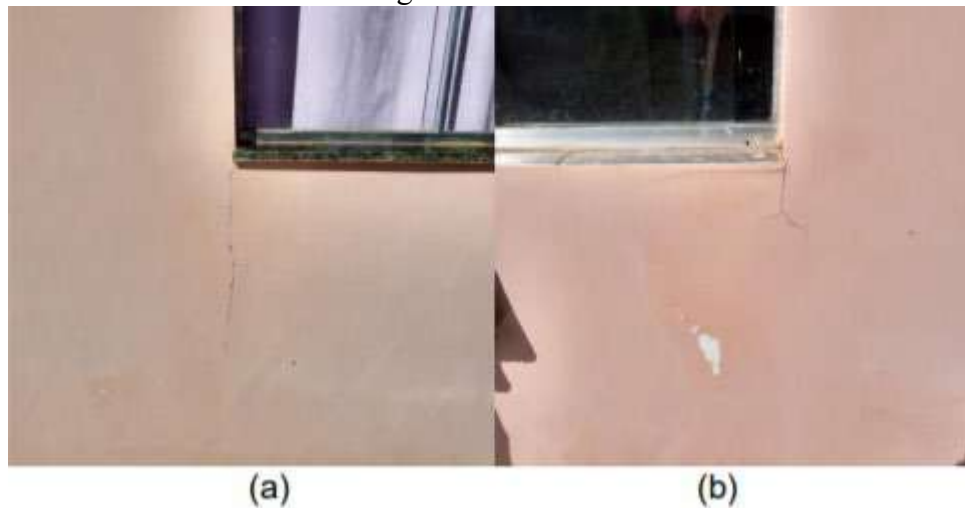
Fissuração em parede de alvenaria na região dos pontos de fixação de janelas
